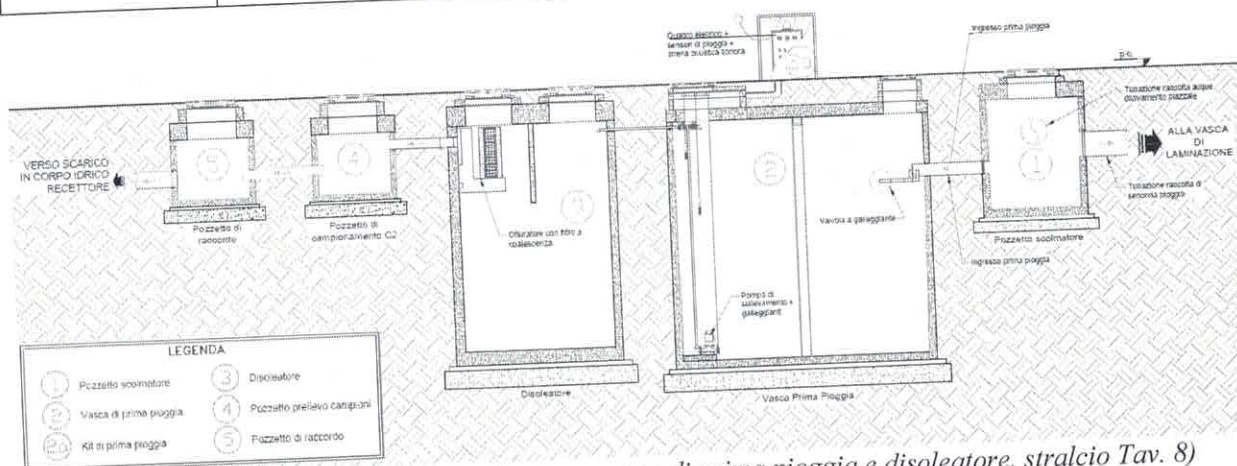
Sezione B-B' (pozzetto scolmatore, vasca di prima pioggia e disoleatore, stralcio Tav. 8)
